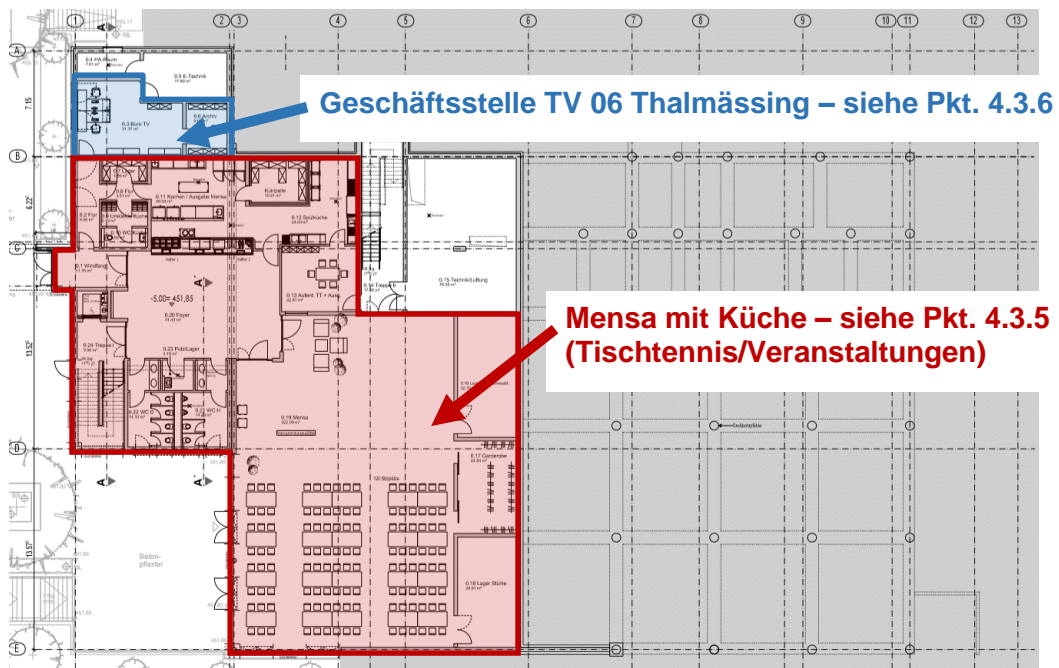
Grundriss Geschossebene 0/UG – Übersicht Nutzungsbereiche
